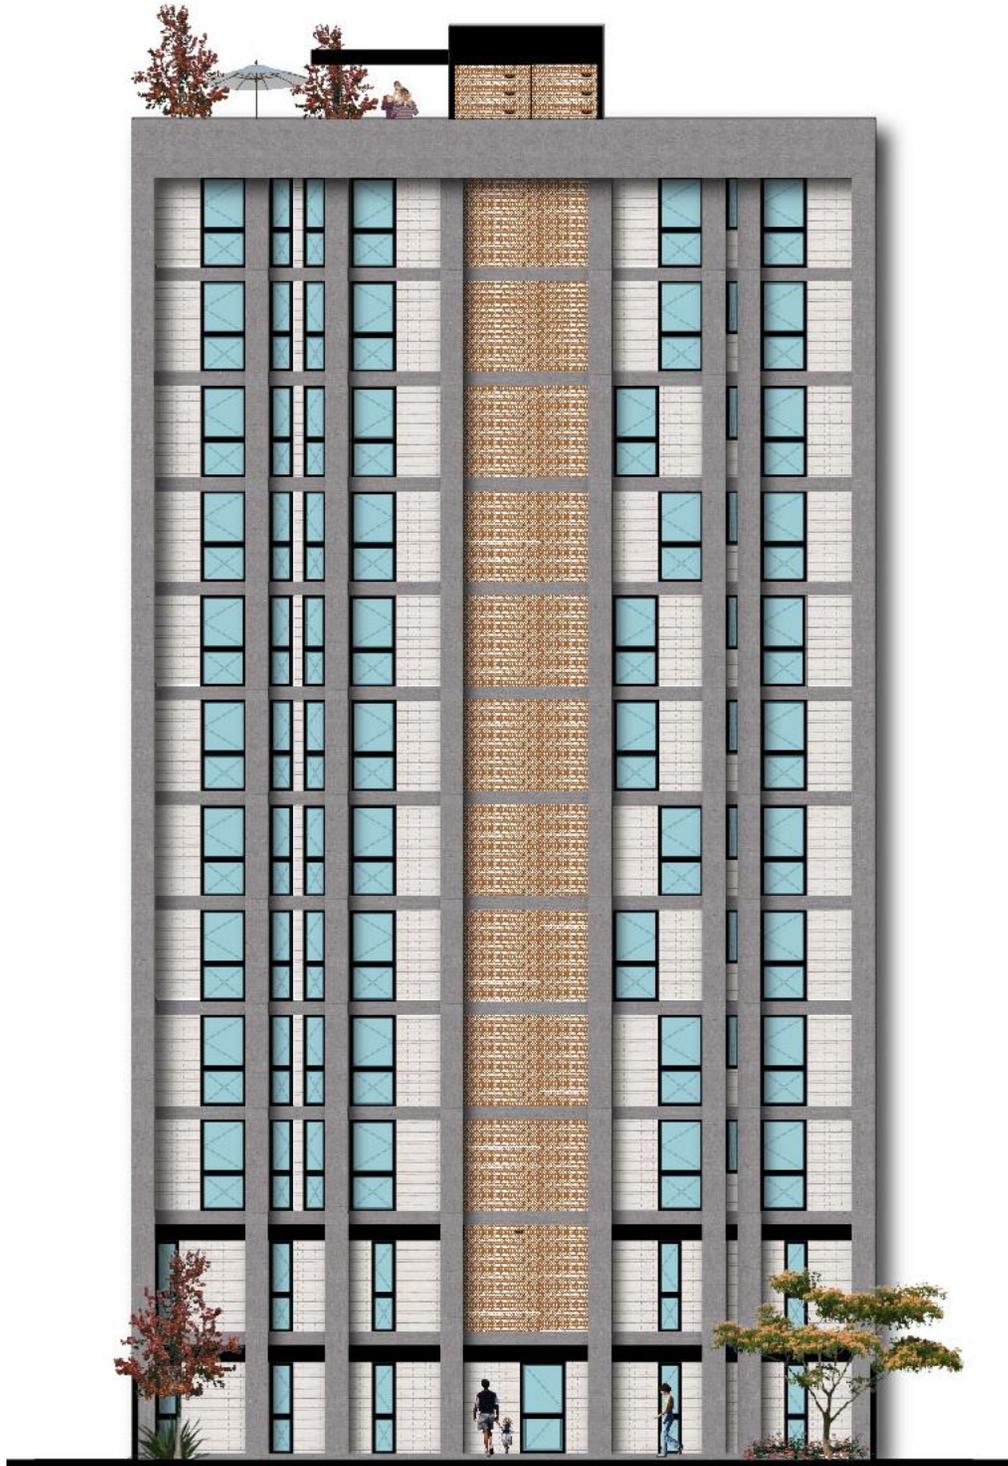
Alzado Posterior Fuente: Elaboración propia
